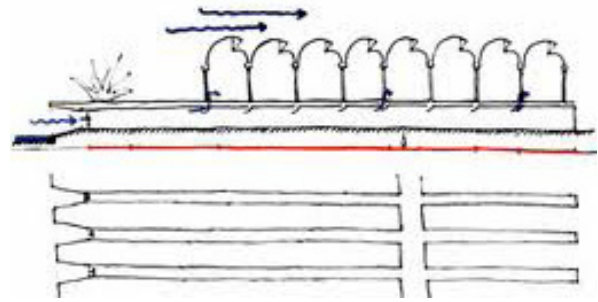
Corte e planta esquemático das galerias de ventilação.
